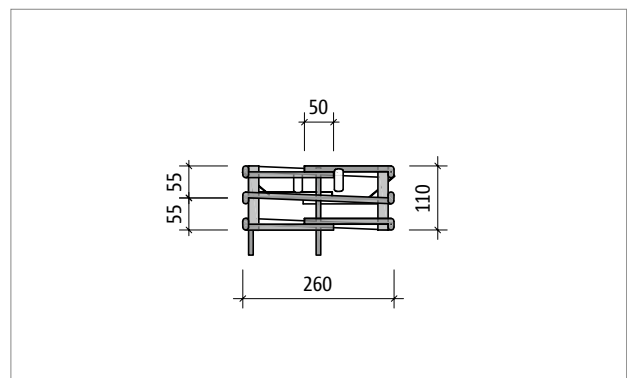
Schöck Sconnex® Typ P-B300: Seitenansicht Part T; geschweisste Bügel und Biegeformsegmente aus Edelstahl
